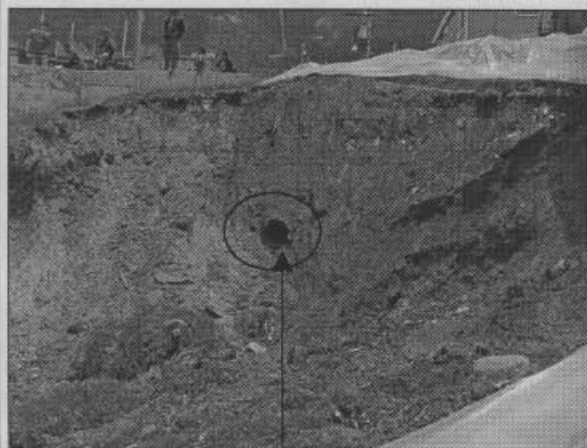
Obsérvese el tubo de alcantarillado aflorando en el escarpe del deslizamiento.
